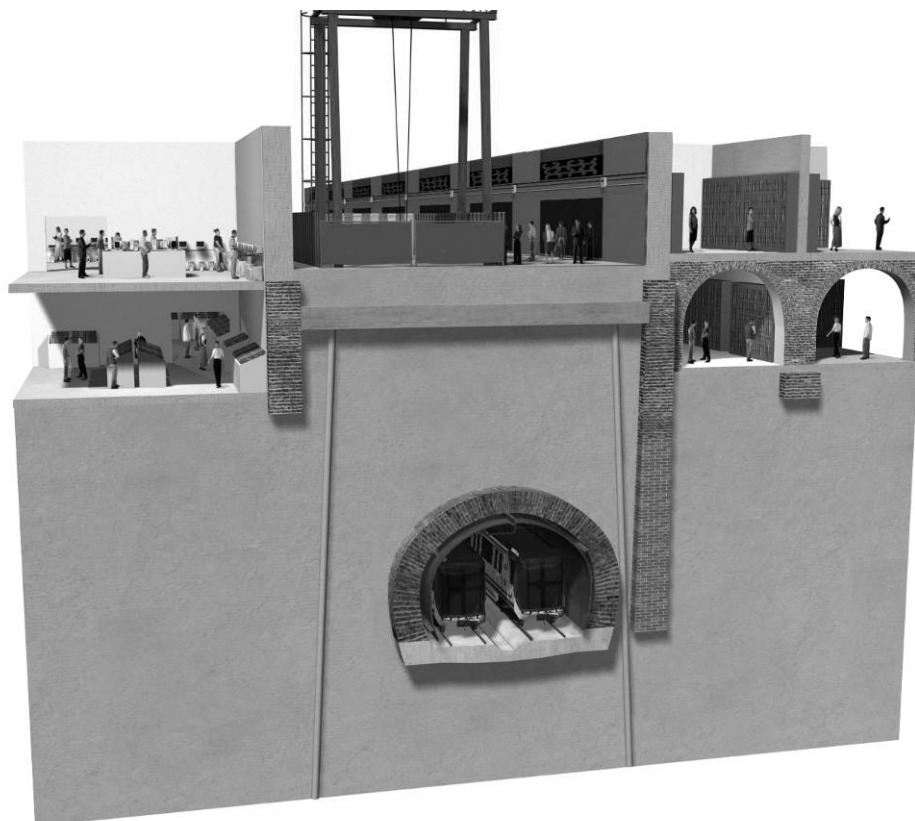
Fase 2: Ejecución de micropilotes y losa de cubierta
